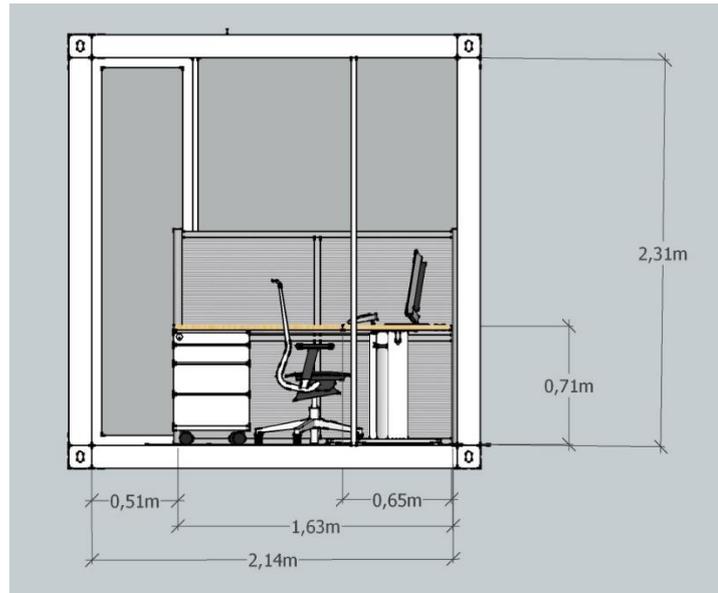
Ukuran Standar Elevation spacial dengan visitor
